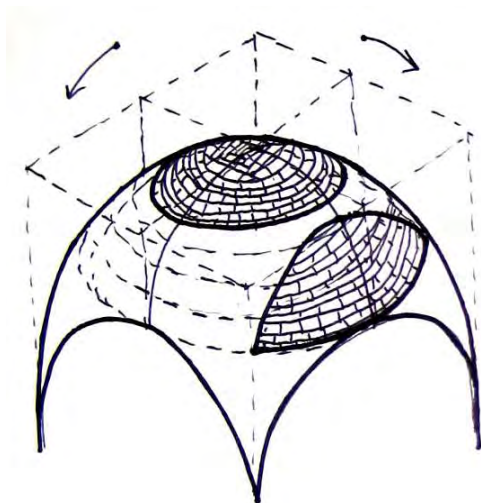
Pormenor do tecto em encaniçado da sala.
